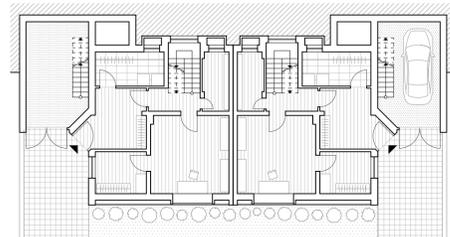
Grundriss Untergeschoss M 1:200
